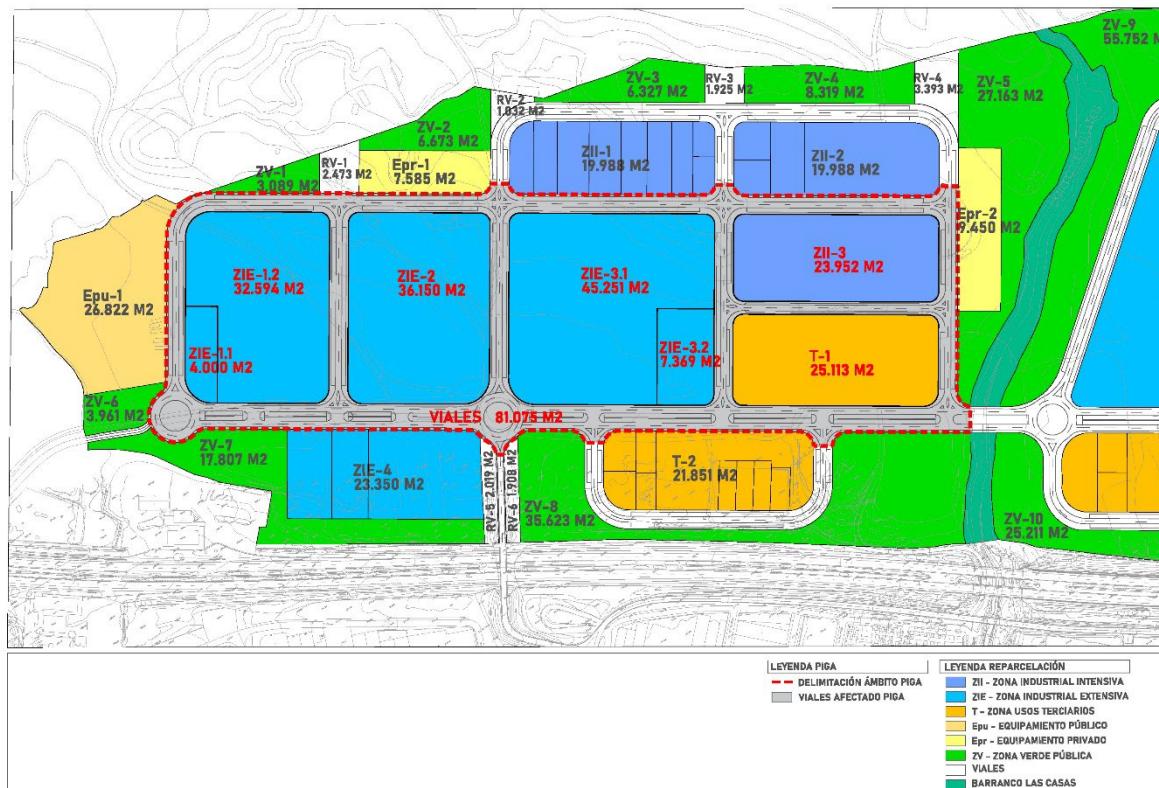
Ámbito del PIGA sobre ordenación existente
